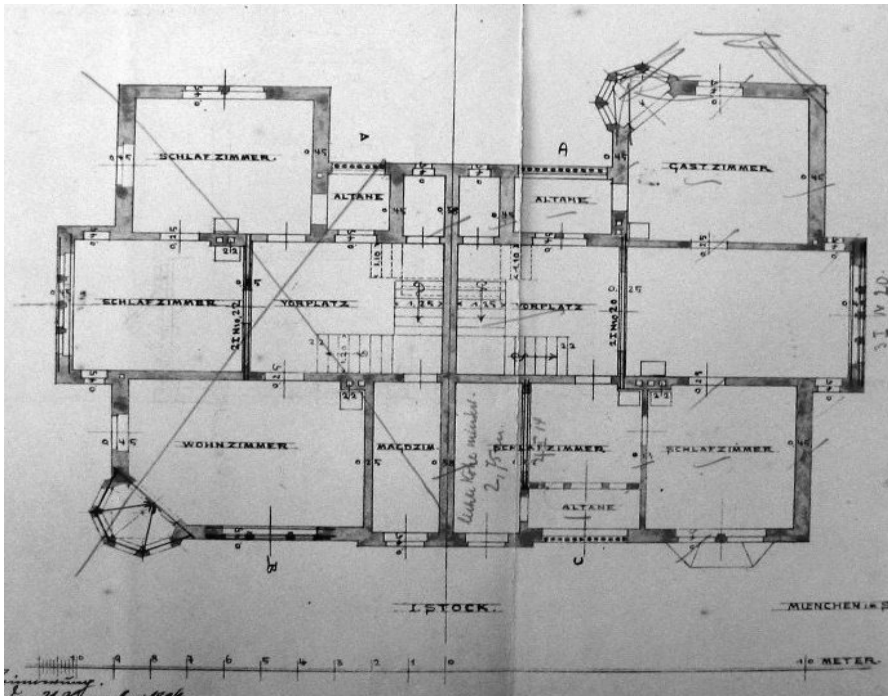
Doppelvilla Plaß/Kerschensteiner, Grundriß erster Stock, Leonhard Romeis, 1896, Plan nach Westen ausgerichtet.
